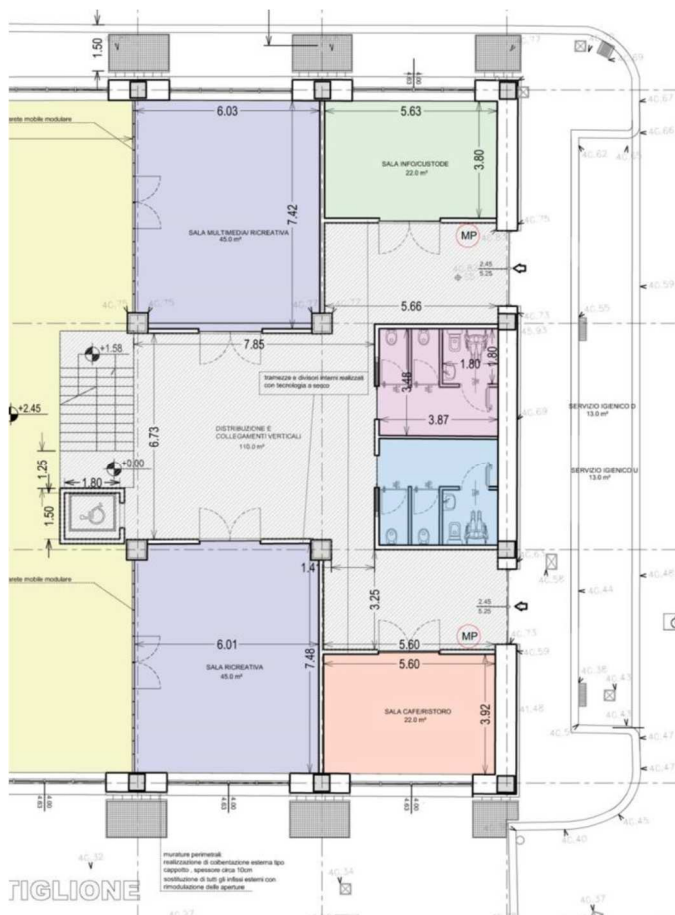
Stralcio planimetrico del piano terra adibito a servizi di quartiere
